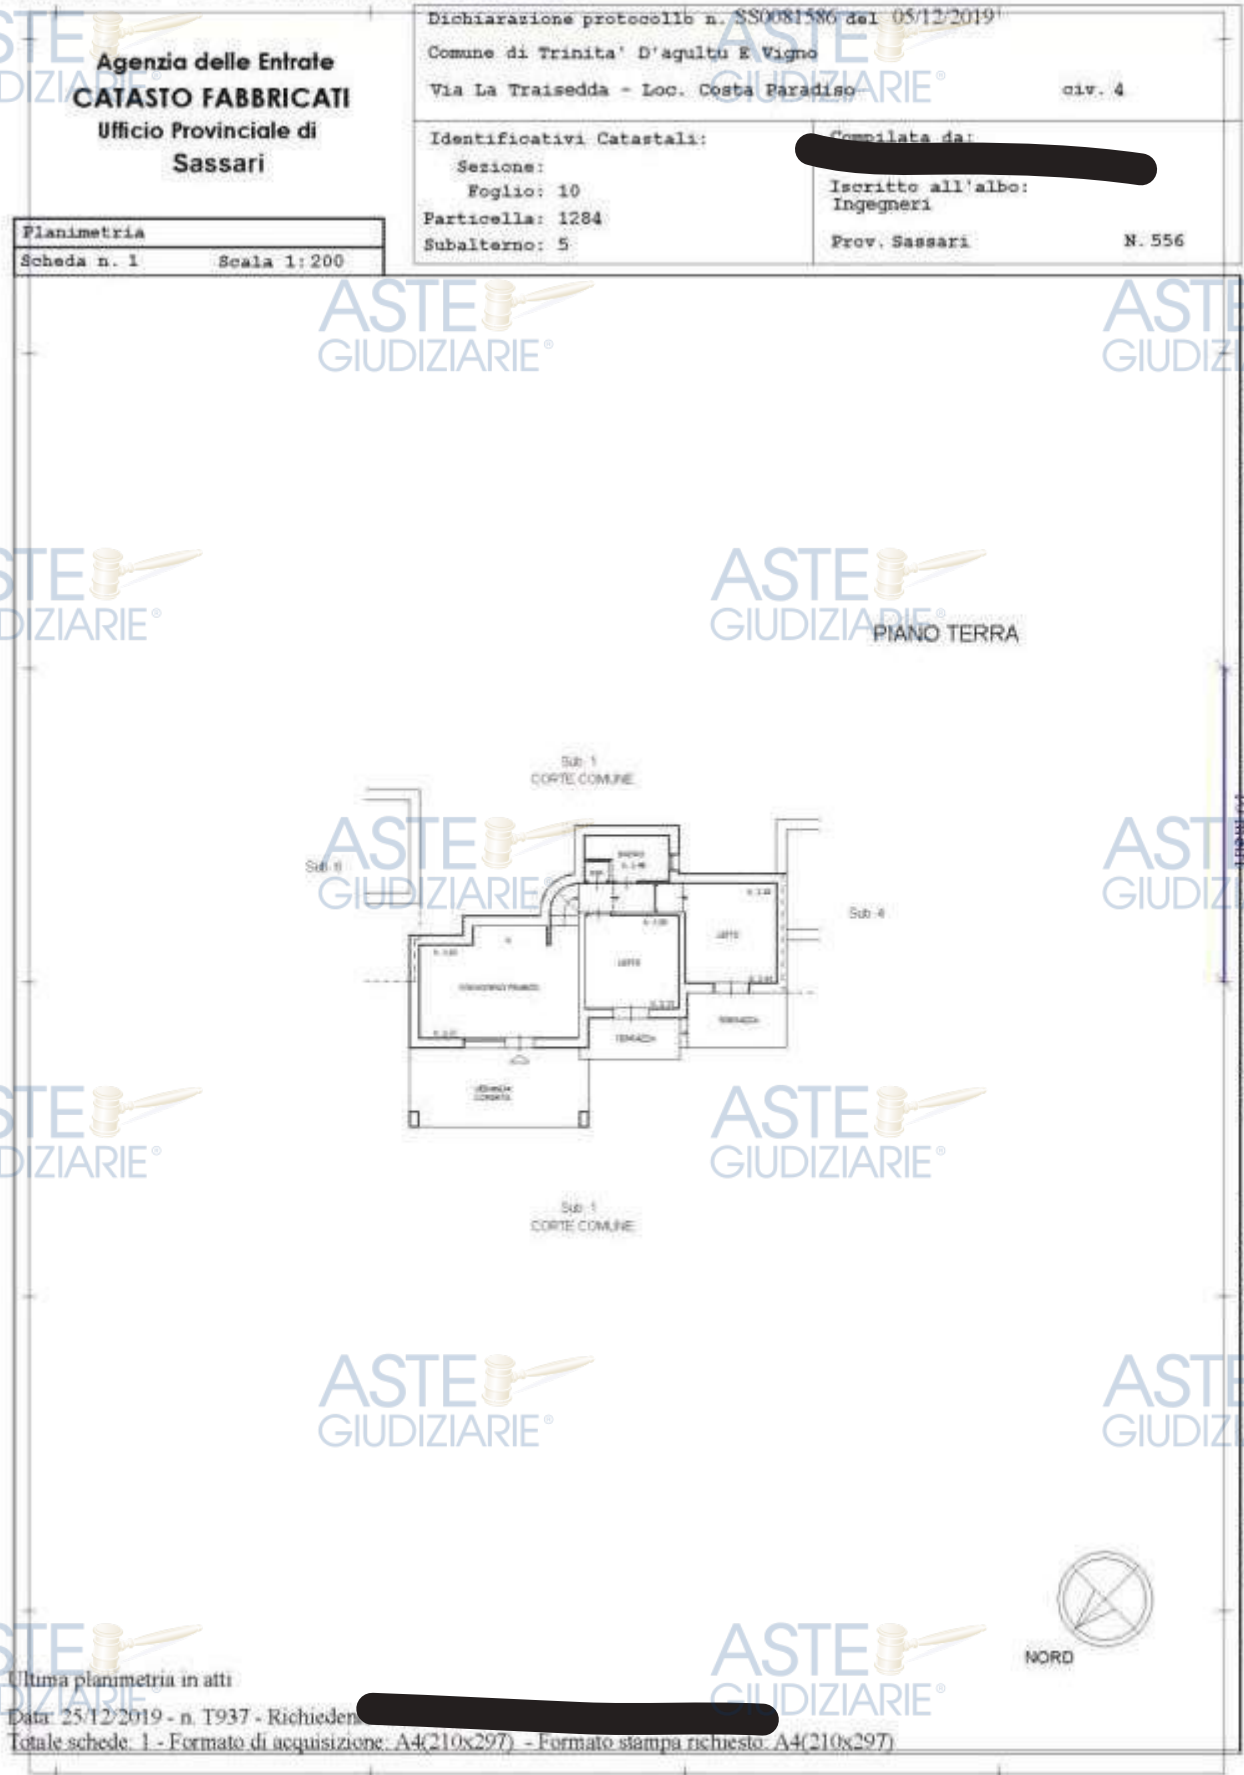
Visura planimetrica catastale aggiornata Fig. 10 Part. 1284 Sub 5
